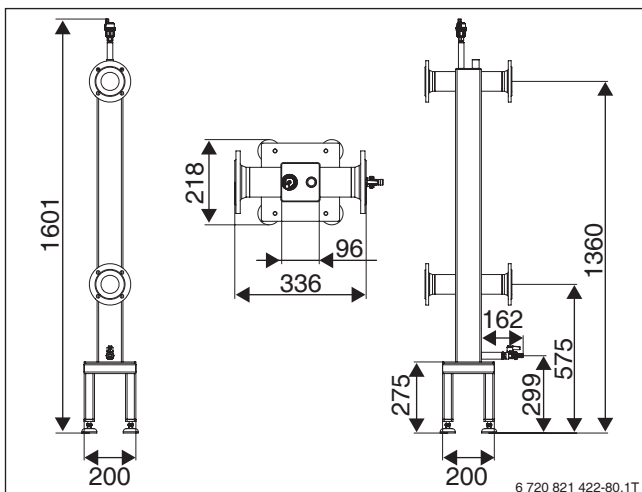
Weichengruppe für 2-Kessel-Kaskade 2 × 75 oder 2 × 100 kW
